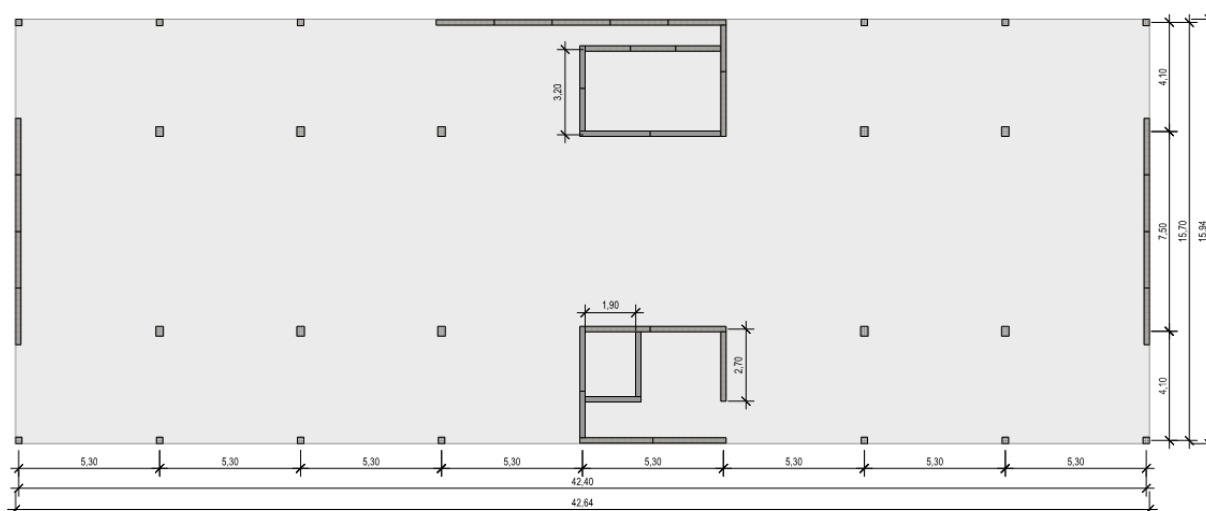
Anordnung der aussteifenden Wände im Grundriss für Konzept 2
